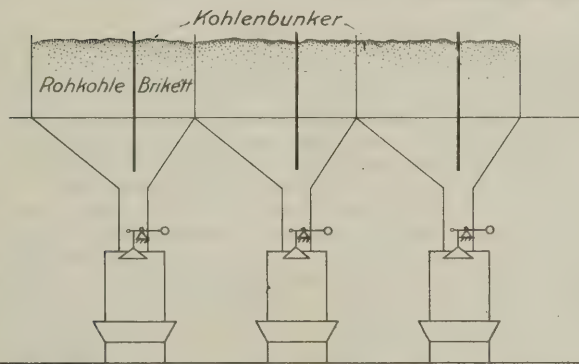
Querschnitt durch die Kohlenbunker und die Gaserzeuger.
